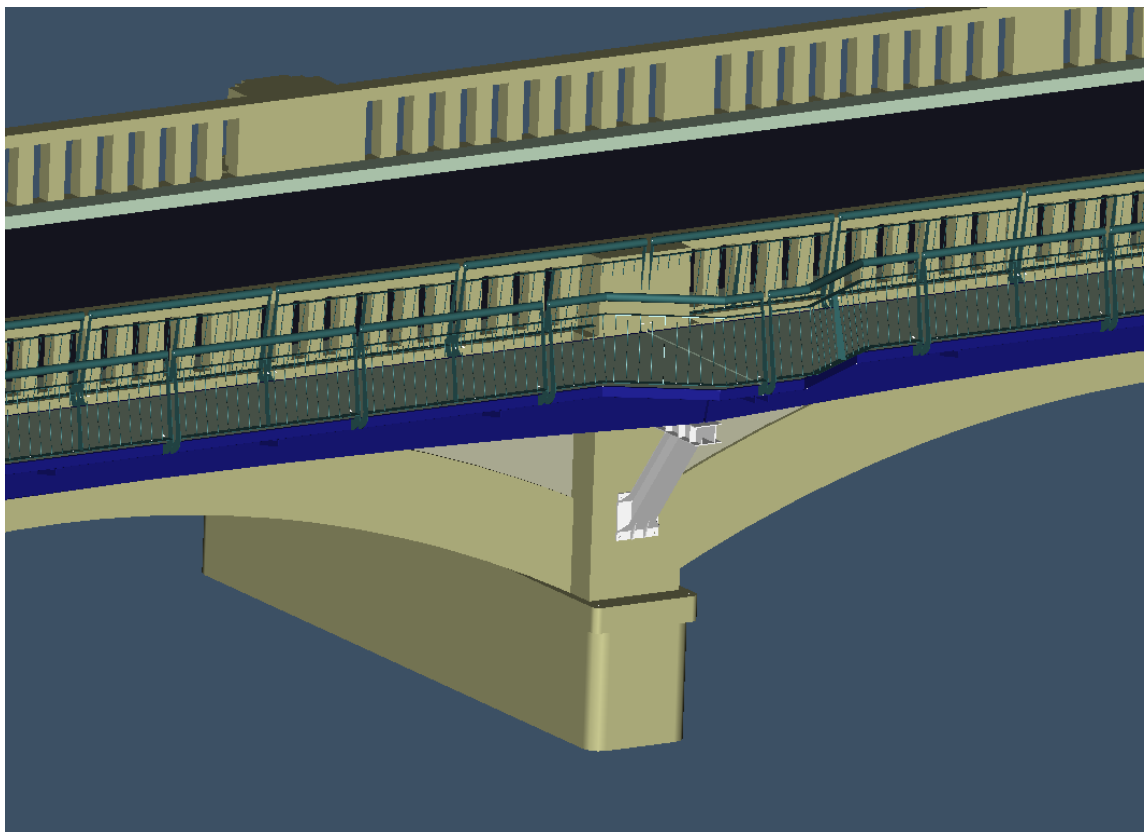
Detalle ménsula intermedia entre pasarela peatonal y puente hormigón
